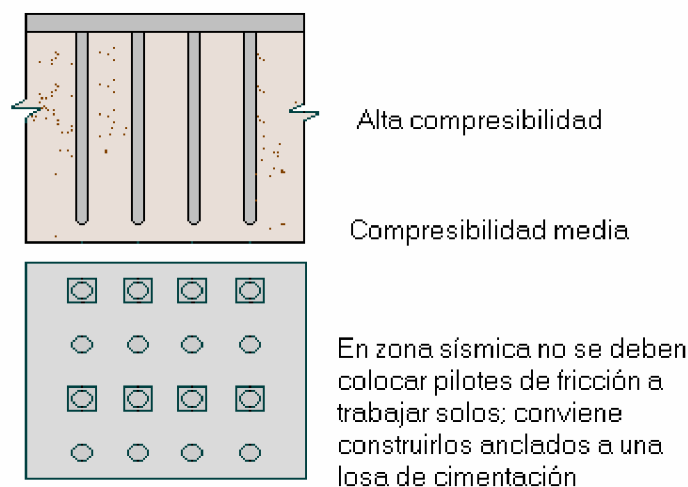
Pilotes por fricción construidos monolíticamente con una losa de cimentación
